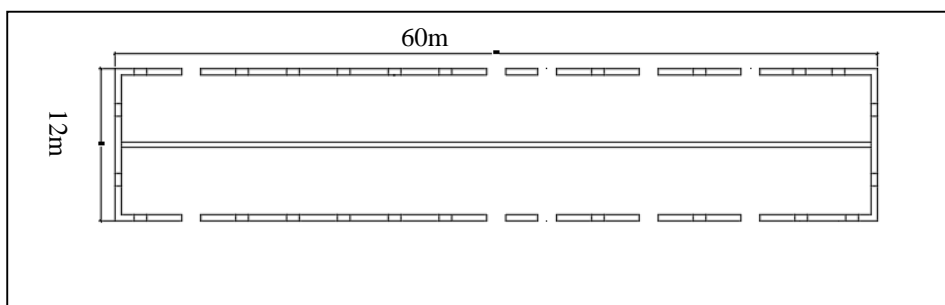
plan d'enveloppe des bâtiments de l'hébergement, source : auteurs
